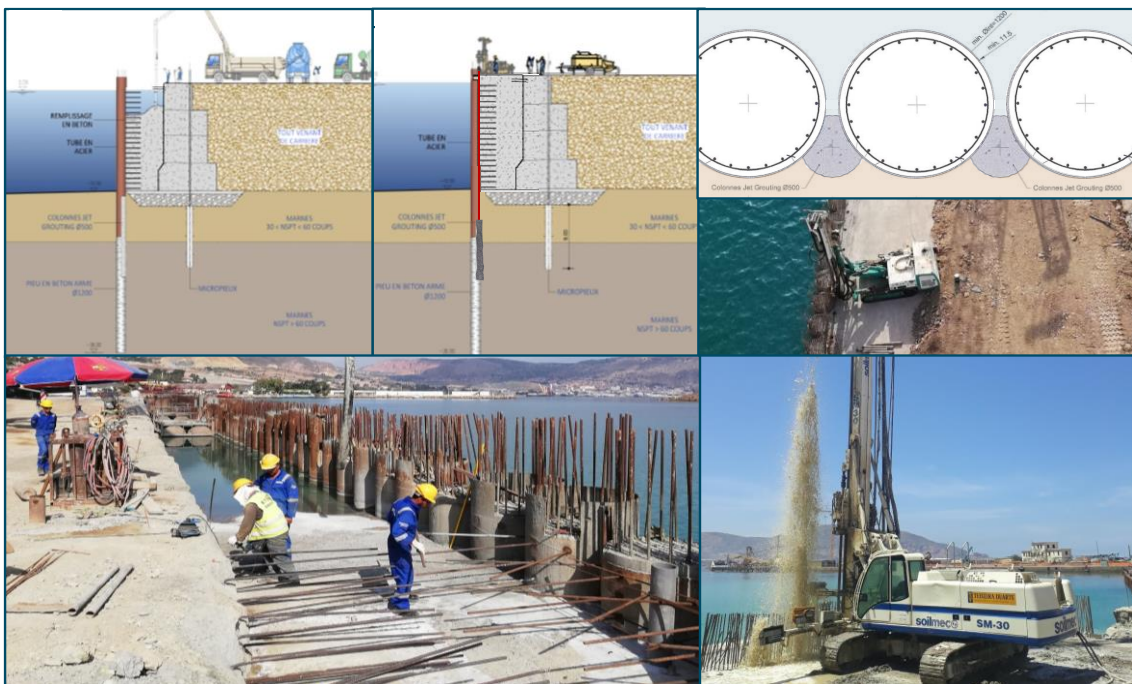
Execução das colunas de jet-grouting e betonagem do espaço entre a cortina e o muro cais existente
